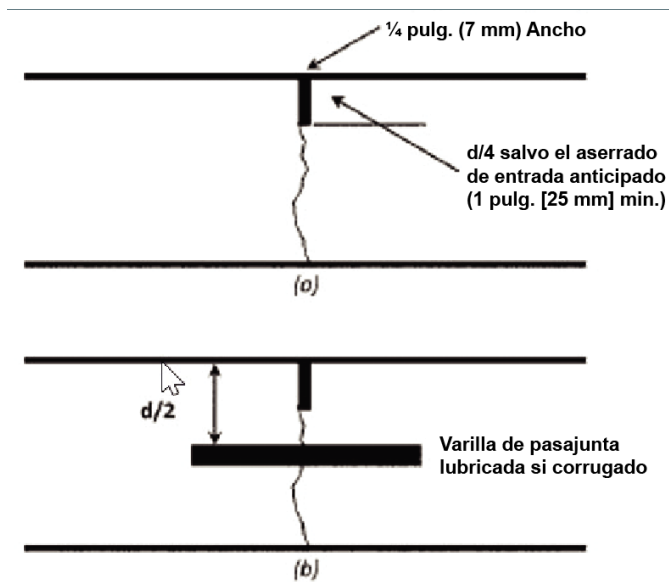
Tipos de juntas transversales de contracción (Fig 4.2 en ACI 325.12R-02(13))
